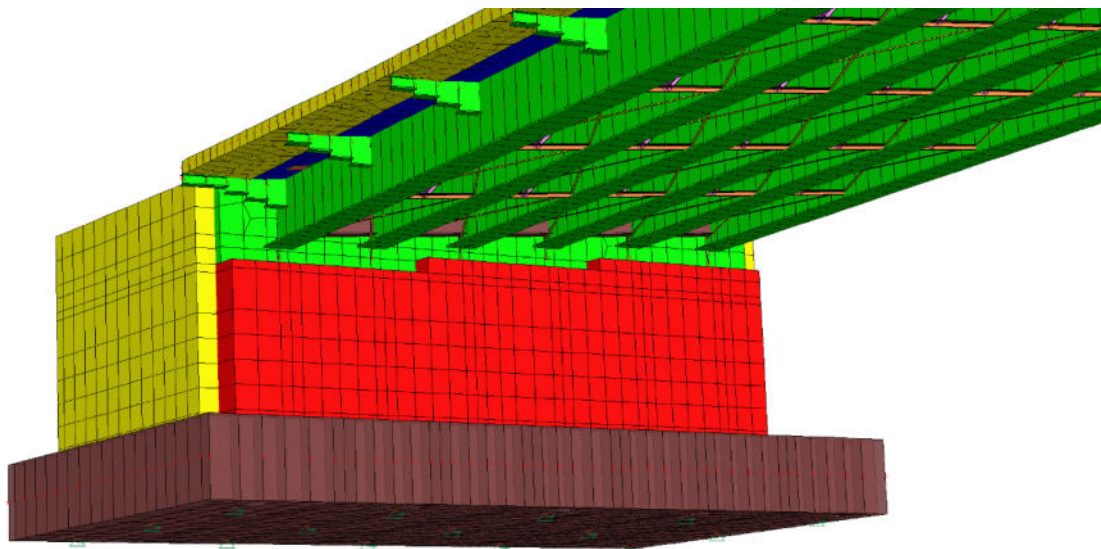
Dettaglio connessione tra spalla ed impalcato
